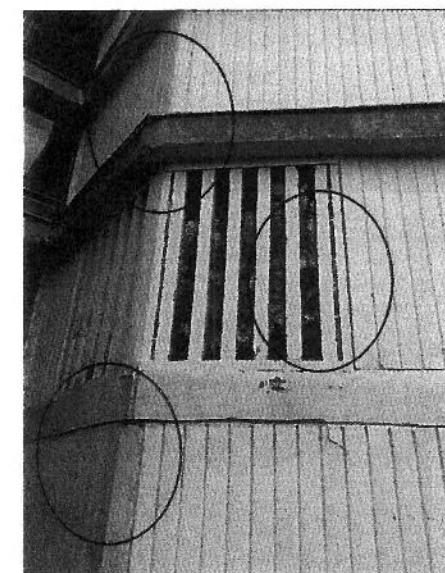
Фасад – неравномерная окраска, отслоение слоя краски. Цоколь – поверхность не подготовлена и не окрашена. Вентиляционная решетка – забита старыми кусками утеплителя.
